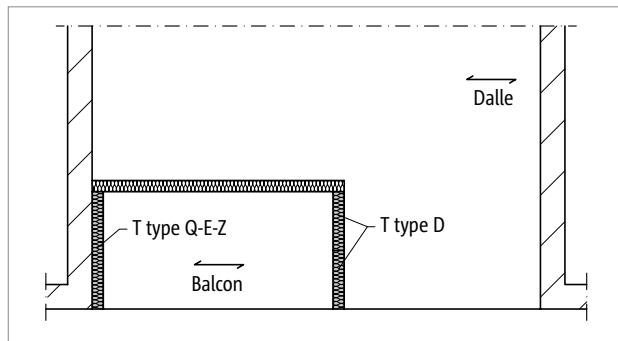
Schöck Isokorb® T Type D, Q-E-Z : Plancher à axe unique
